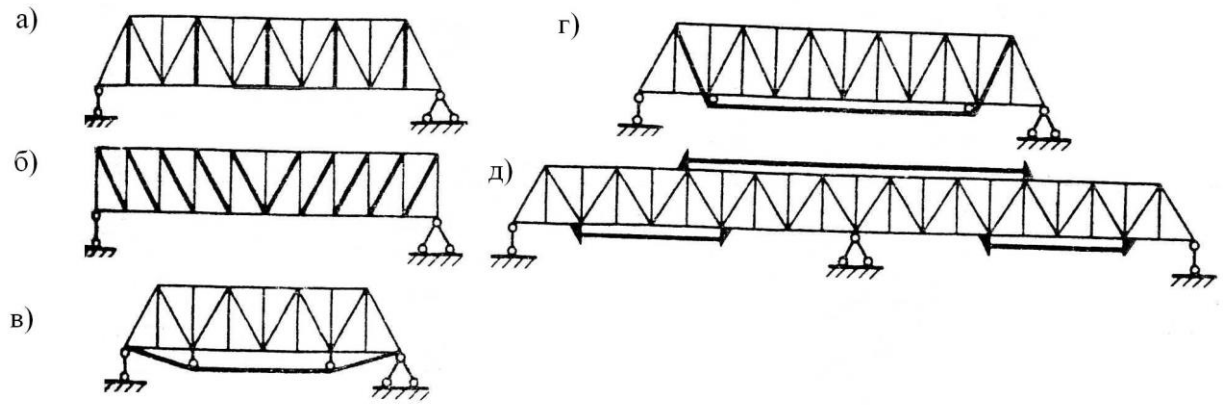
Схемы усиления главных ферм предварительно-напряженными
